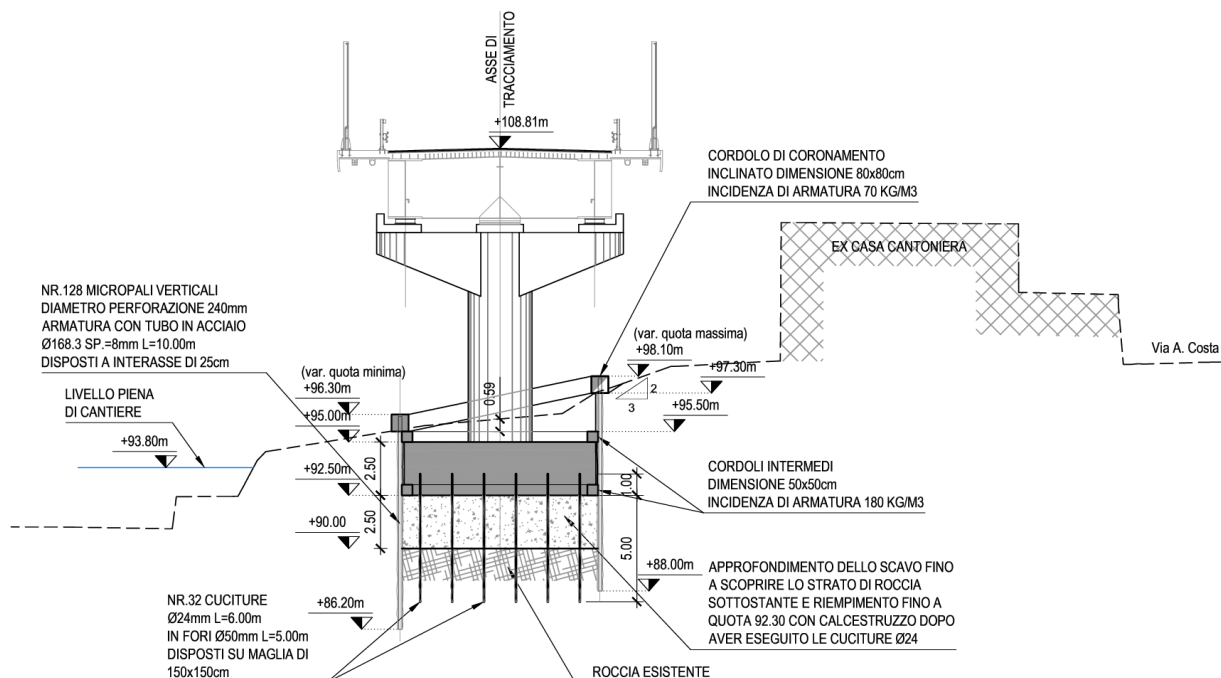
Sezione trasversale opera provvisoriale pila 4.
